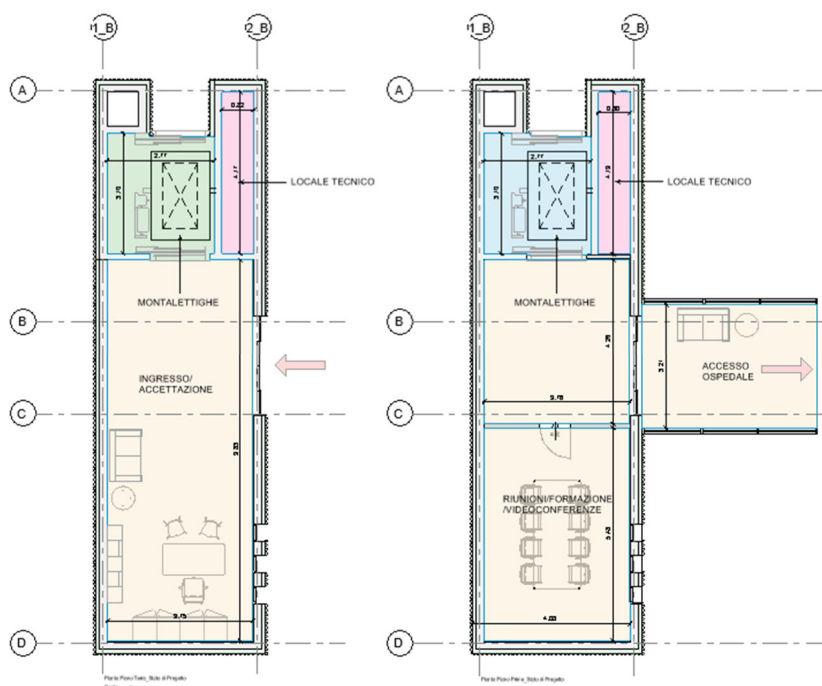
Pianta Piano Terra (sinistra) e Piano Primo (destra)
